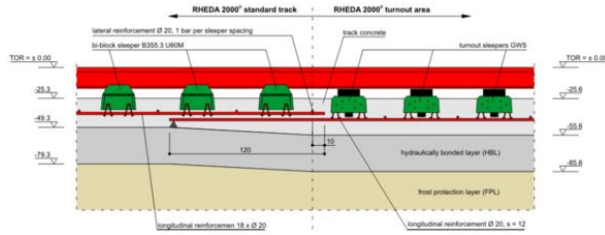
Detalle de la transición entre la vía en placa Rheda 2000 para vía general y la zona de desvíos
